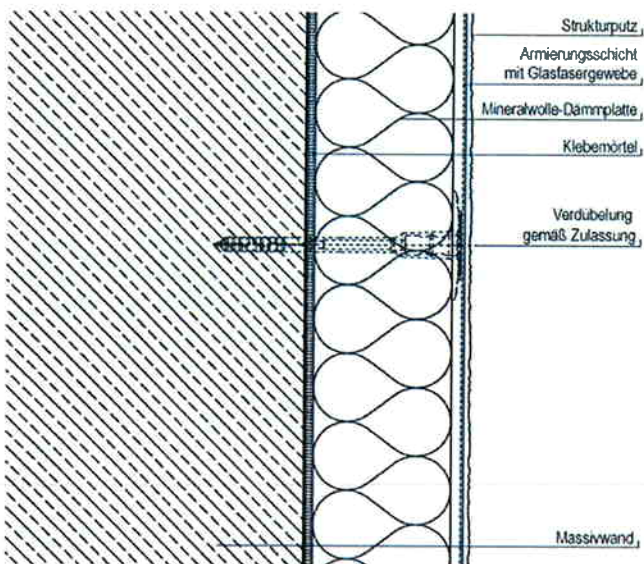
Aufbauprinzip eines Wärmedämmverbundsystems mit Putz als Deckschicht [6]
